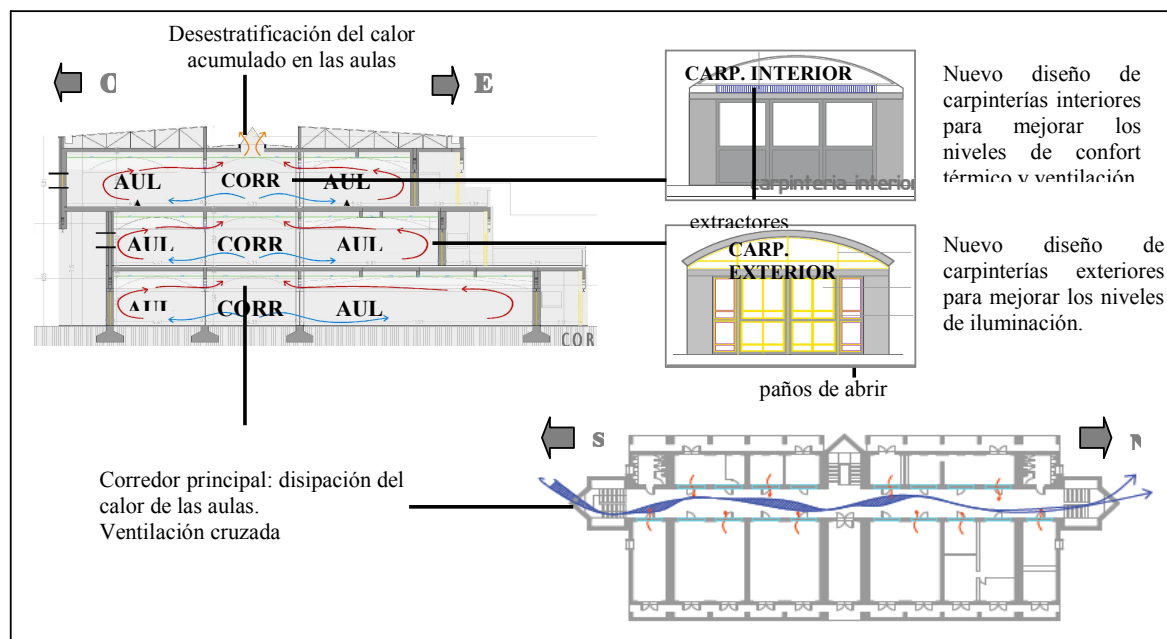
Se muestra en corte, planta y vista las estrategias planteadas para mejorar la ventilación y el acondicionamiento térmico.
